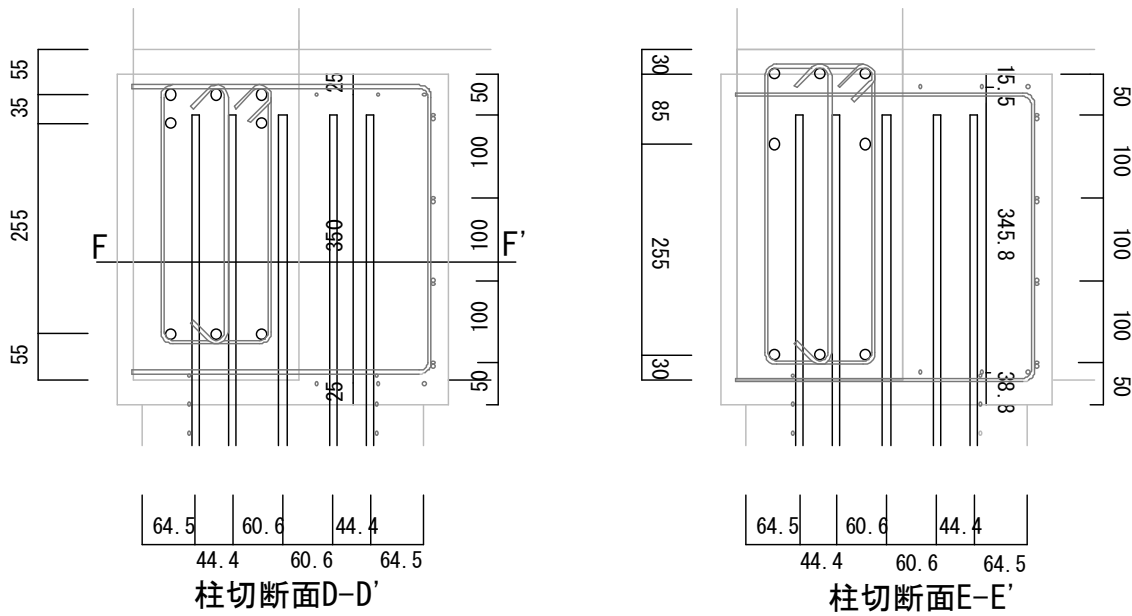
E39 試験体配筋状況 (杭頭接合部切断面)
